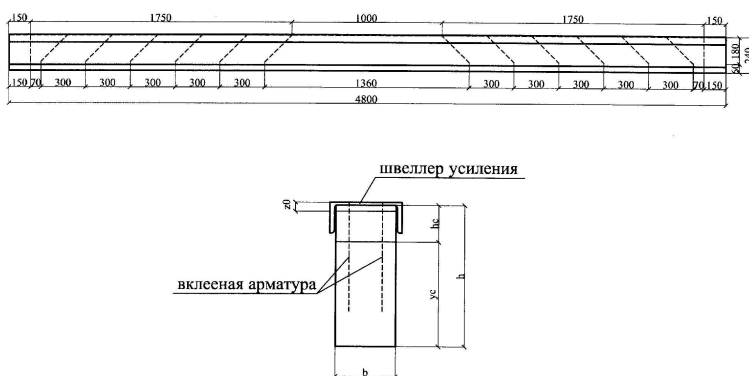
Конструкция и поперечный разрез композитной балки перекрытия.
